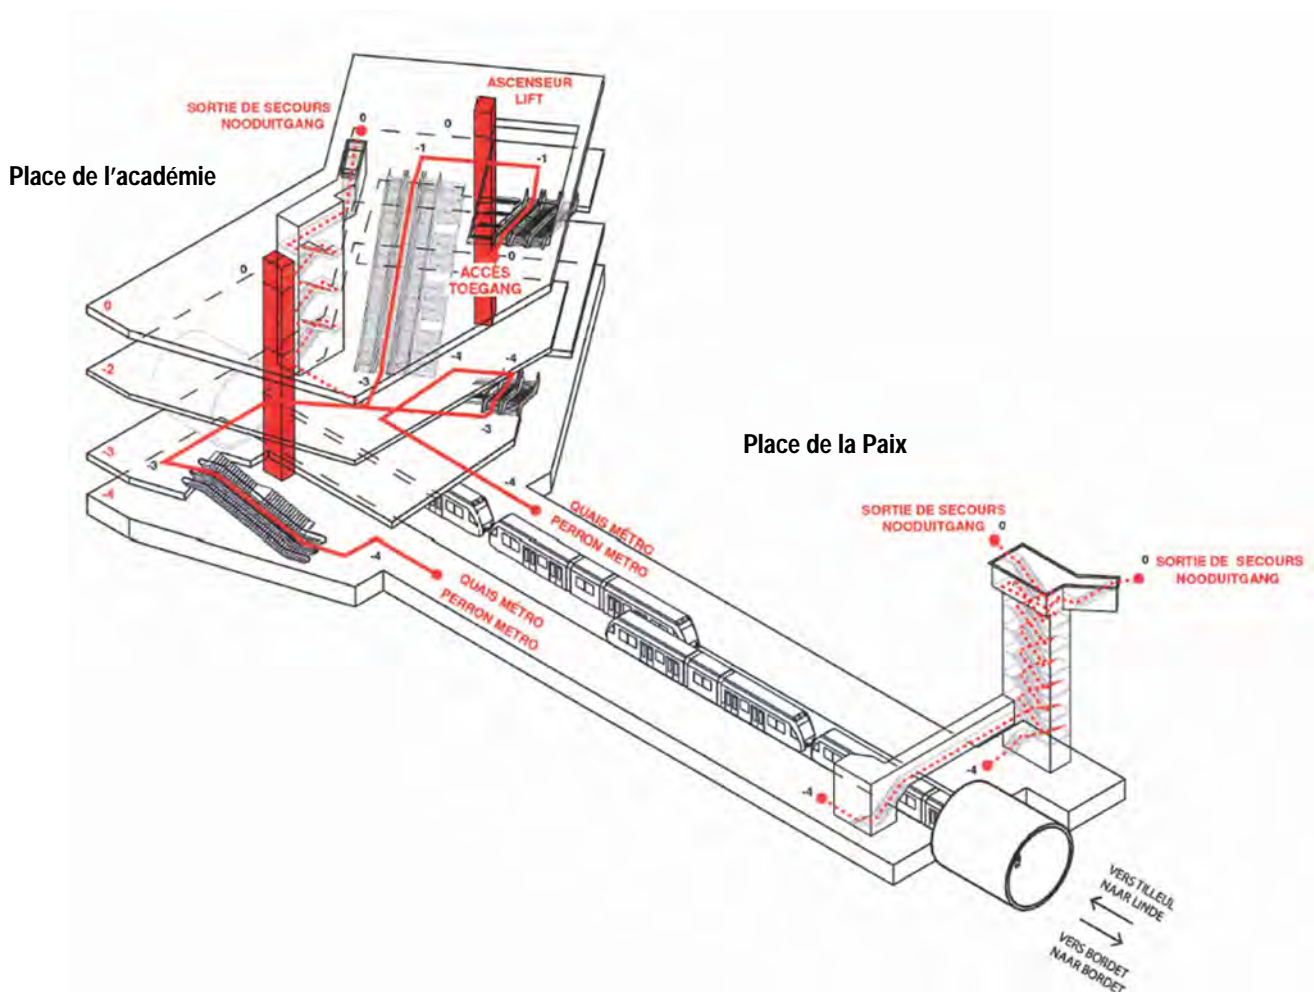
Station Paix, coupe technique (BMN, 2018)
